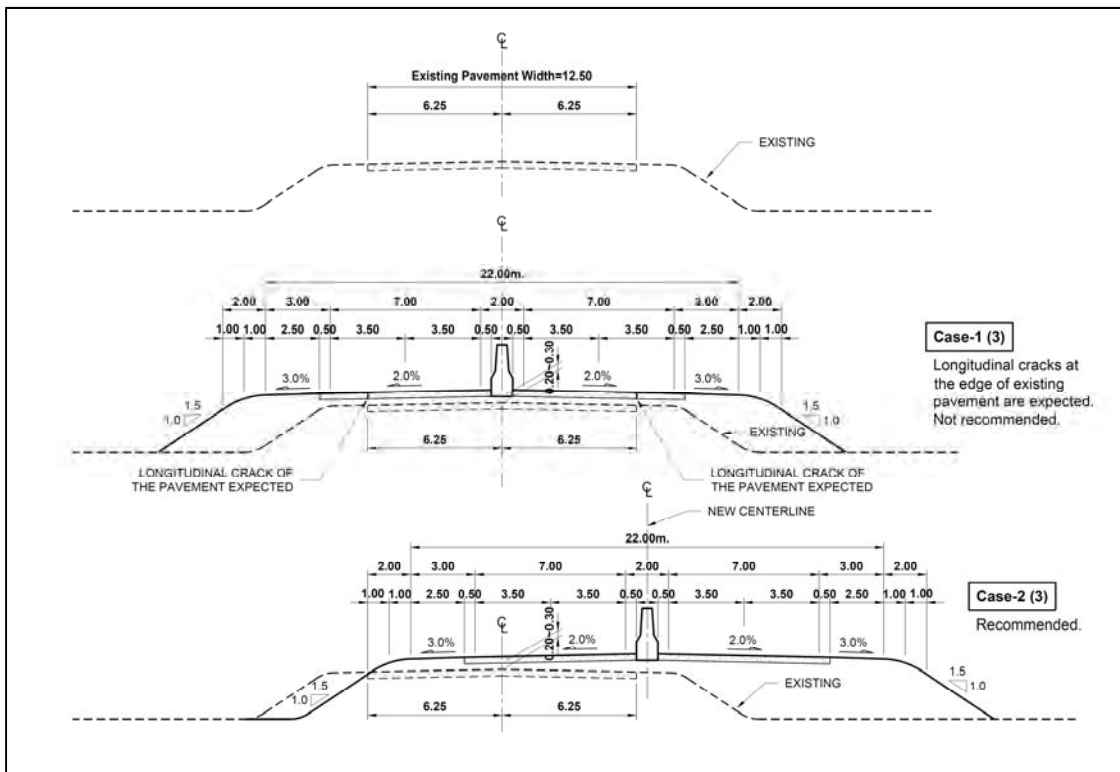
標準横断面パターン-3: 既存舗装幅= 12.5m
